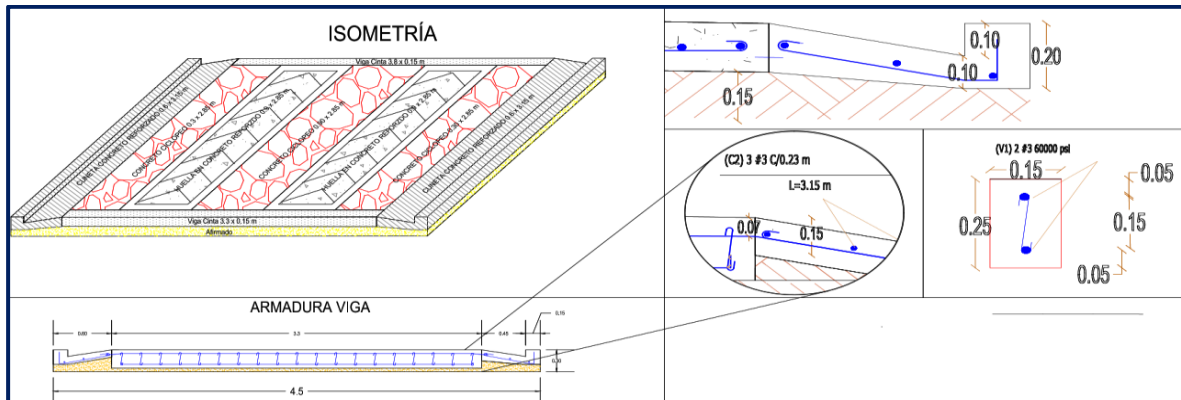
Vista de armadura de sección de la viga diseño placa huella de 4.5 m
